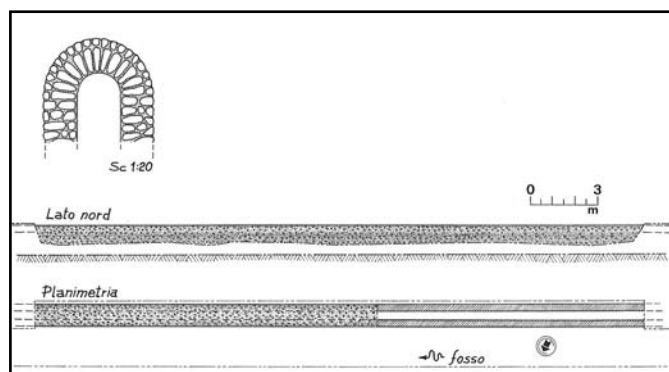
Restituzione grafica dell'acquedotto secondario con veduta e sezione (dallo scavo del 1962; disegno P. Barale).
